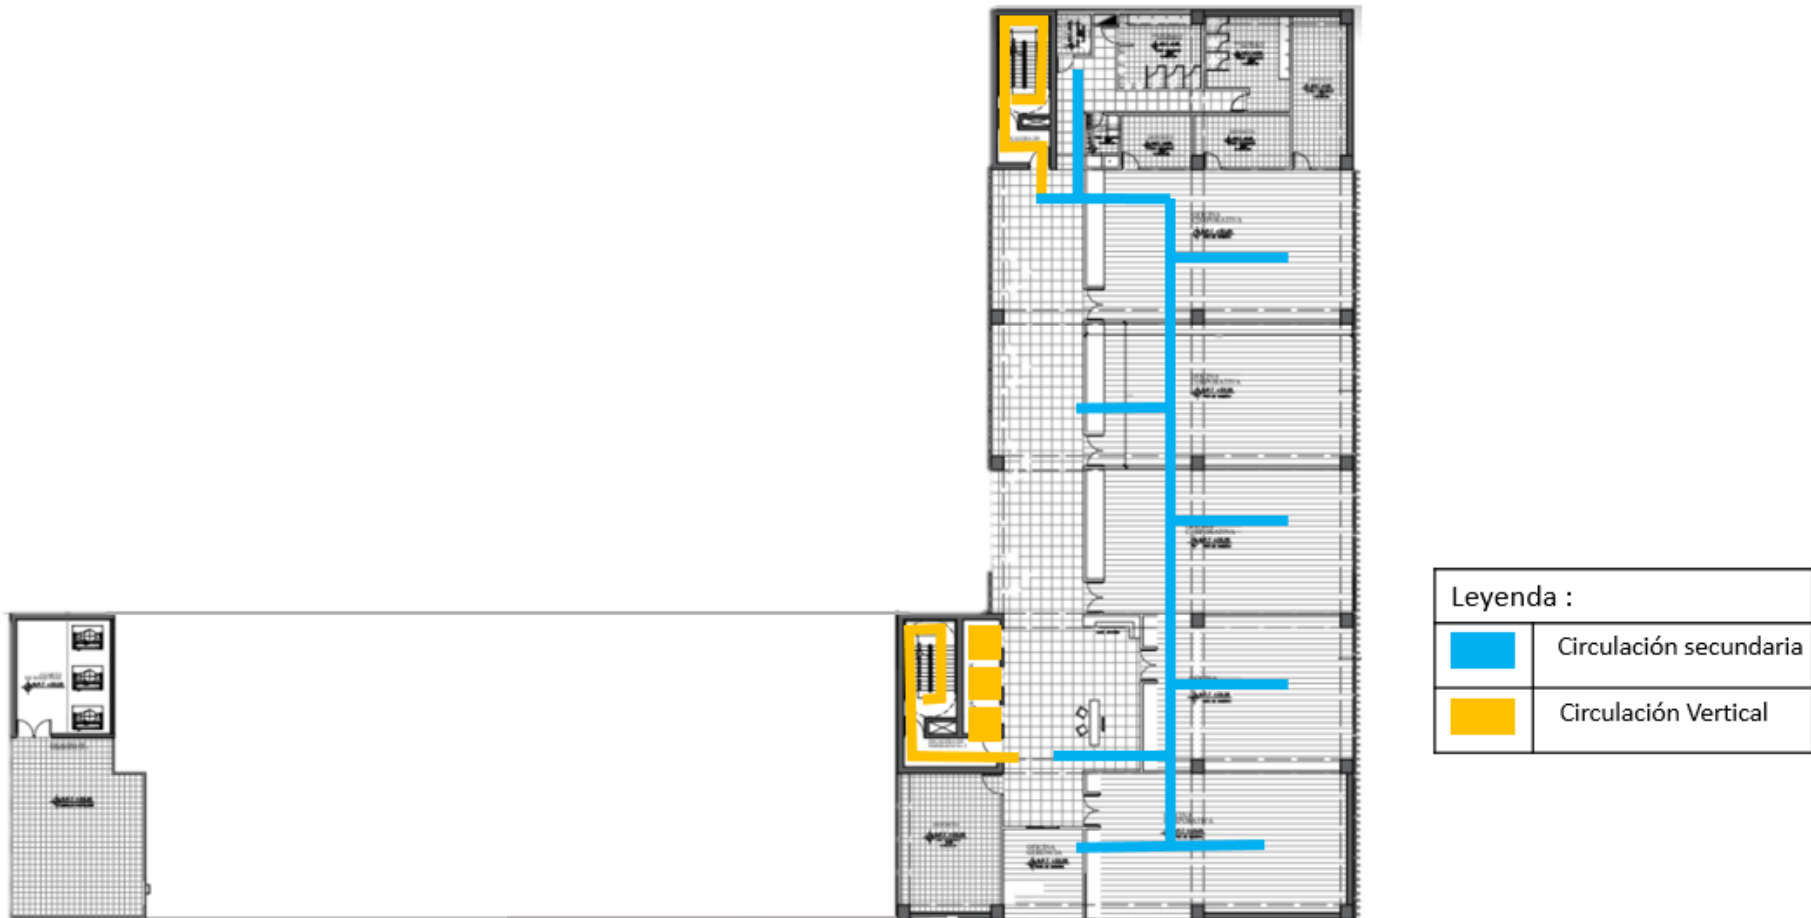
Plano de planta típica – circulación decimo al quinceavo nivel.
